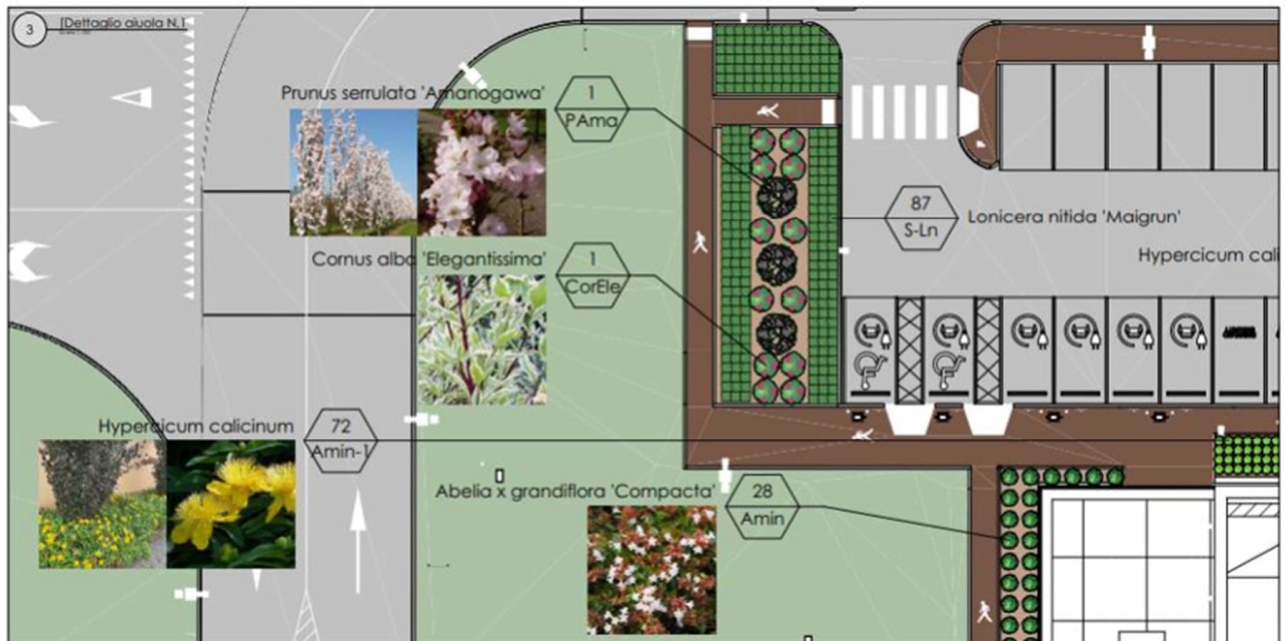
Estratto del Progetto - Aree Verdi Dettaglio Ingresso
